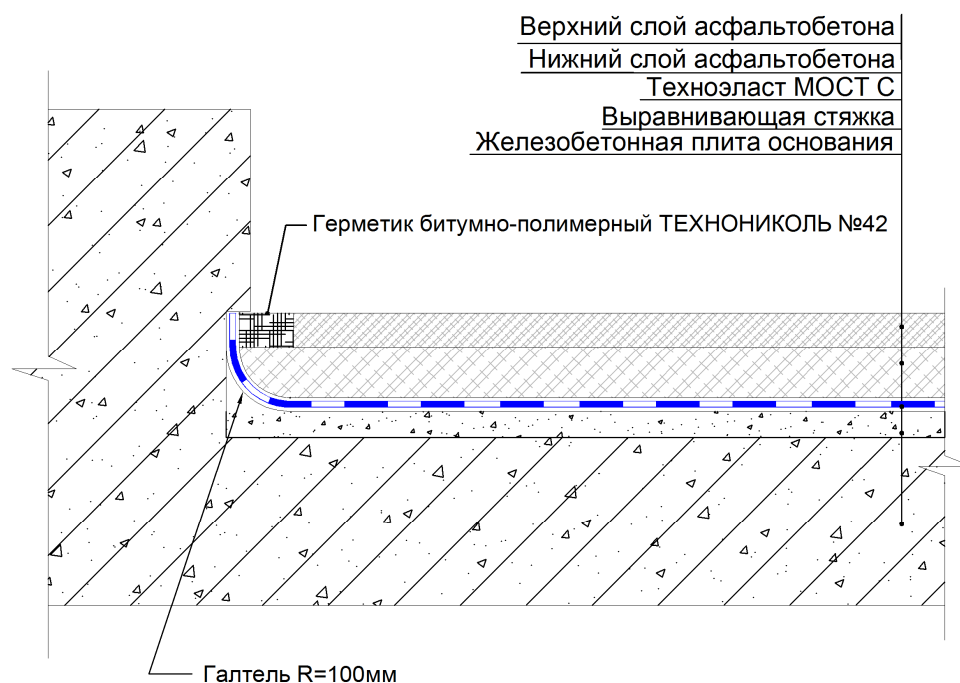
Примыкание гидроизоляции к вертикальной поверхности.
